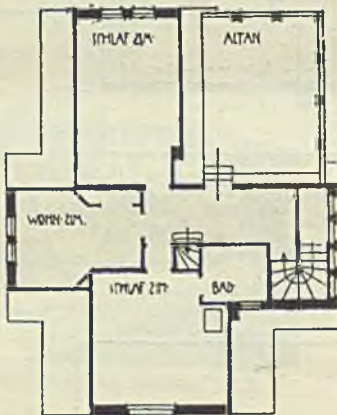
Landhaus Krill in Buchschlag, Erdgeschoß
